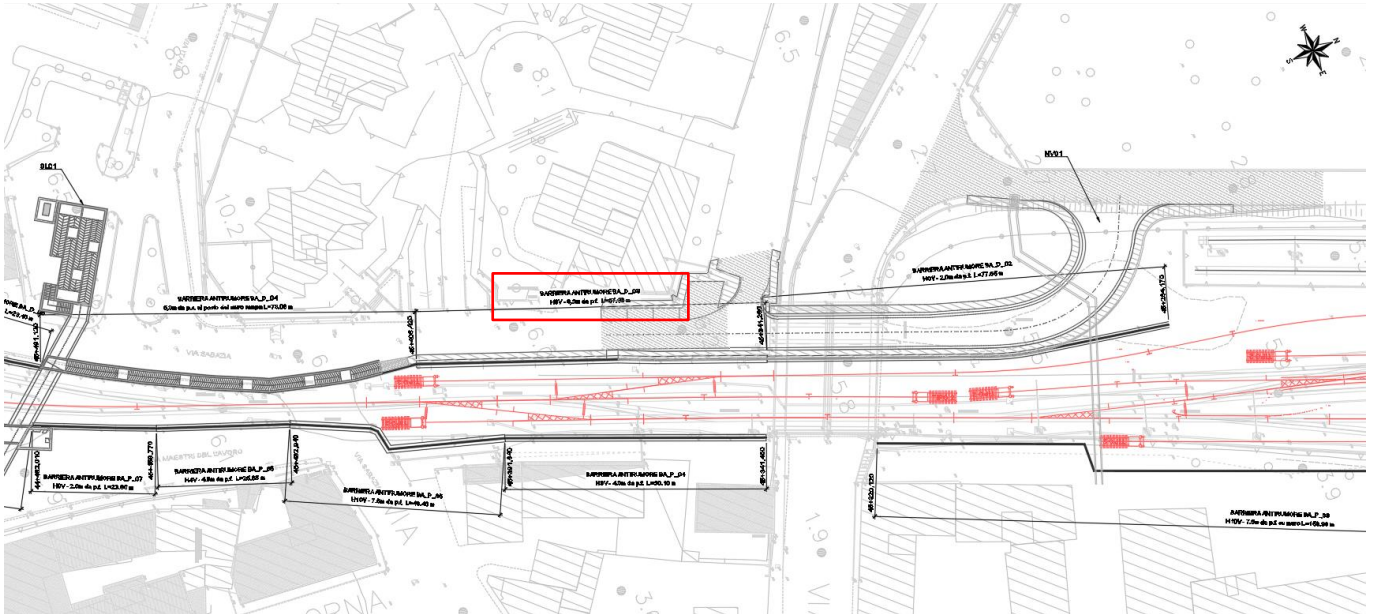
Planimetria di progetto – Barriere H8-H10 – 1 / 2
